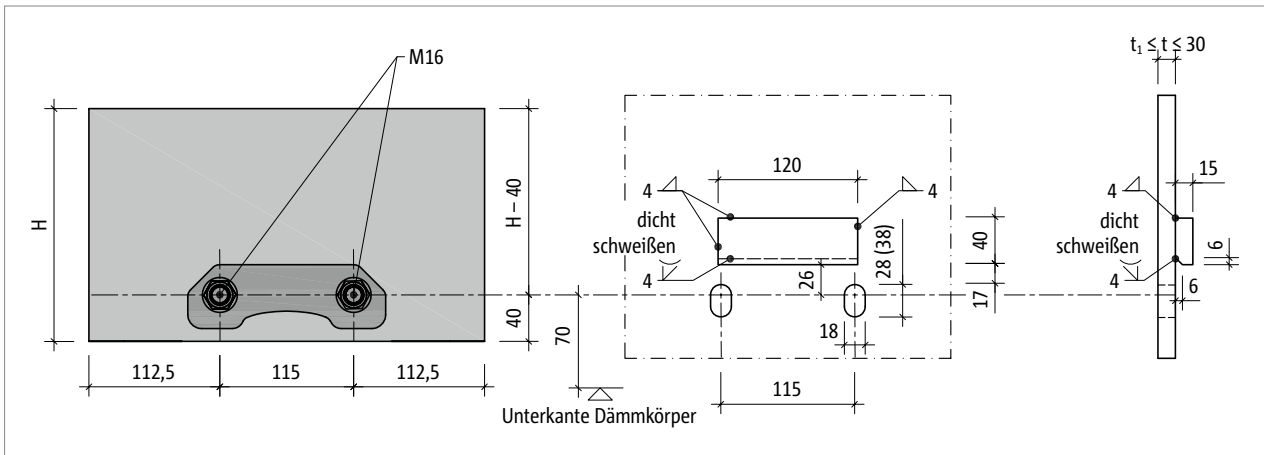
Schöck Isokorb® RT Typ SQ: Konstruktion des Stirnplattenanschlusses
